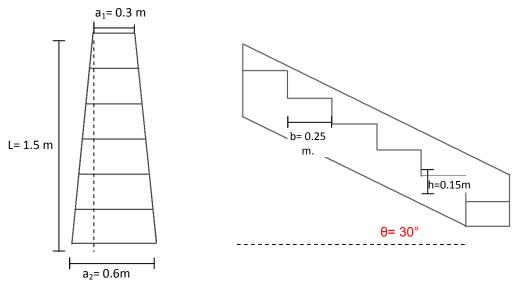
Vista en planta y sección longitudinal. Escaleras de oxigenación
